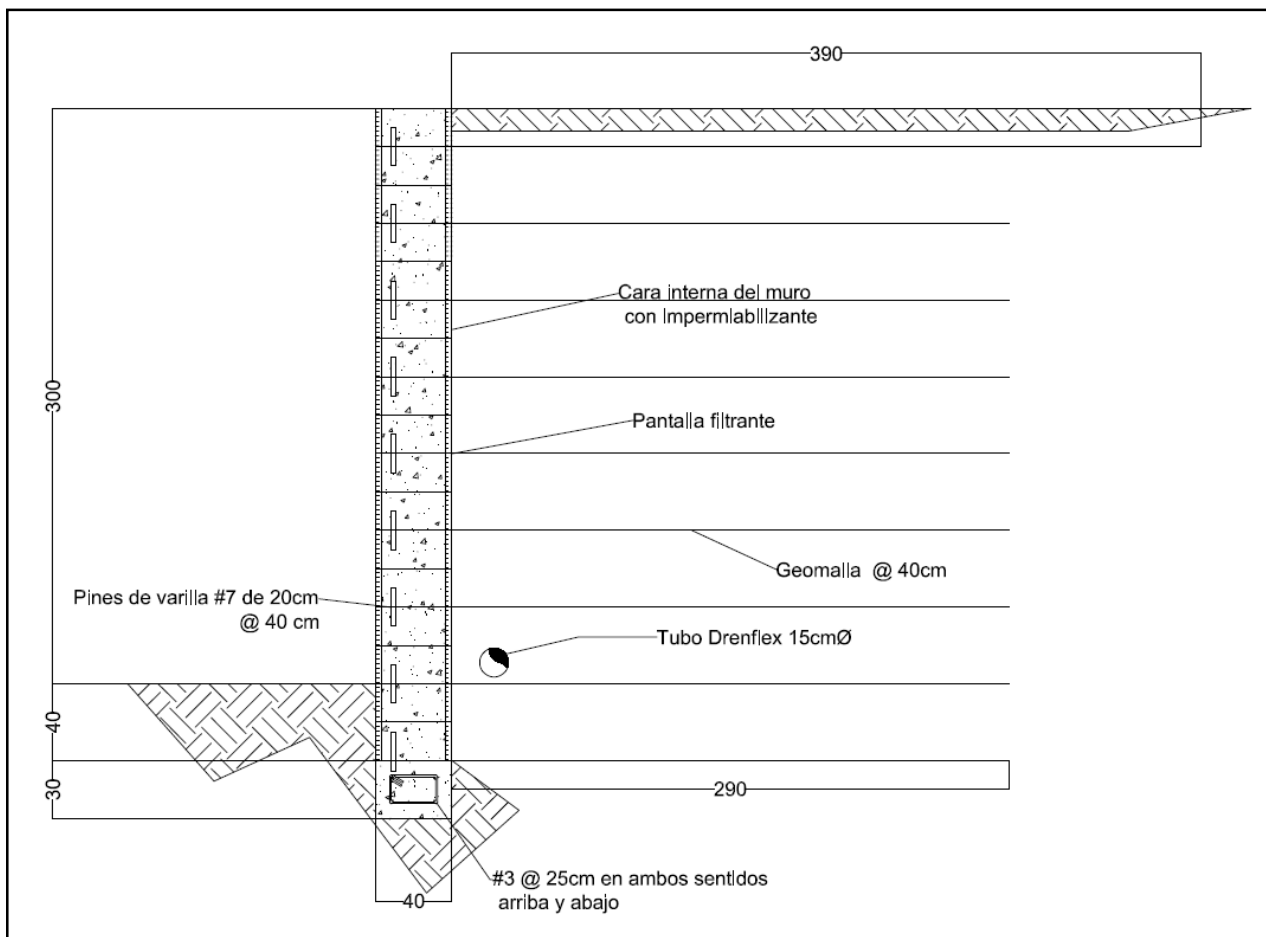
Esquema muro suelo reforzado 3 m cotas en cm
